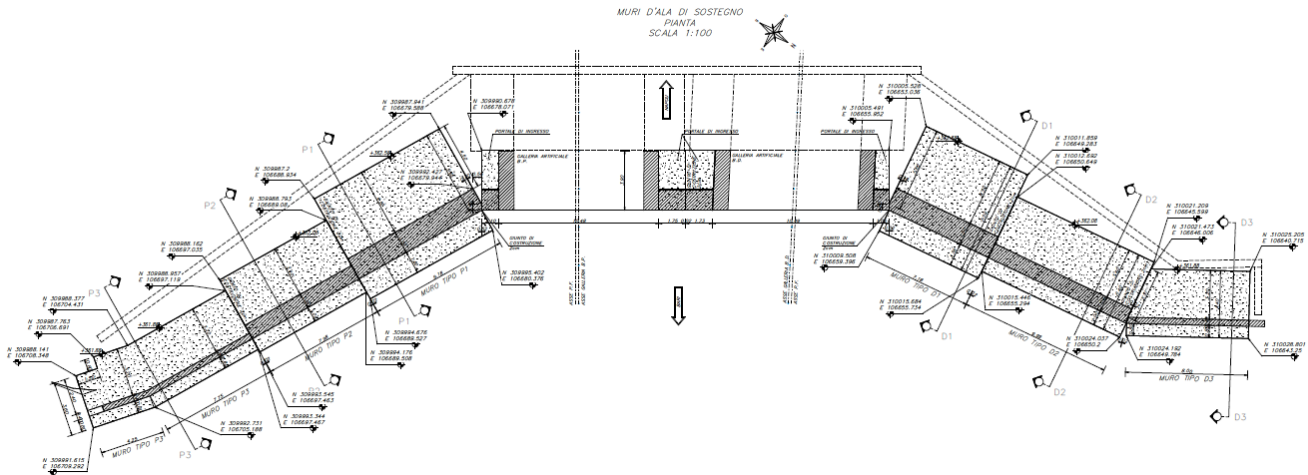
Planimetria delle opere di imbocco della galleria Hirpinia lato Bari – Fase definitiva
